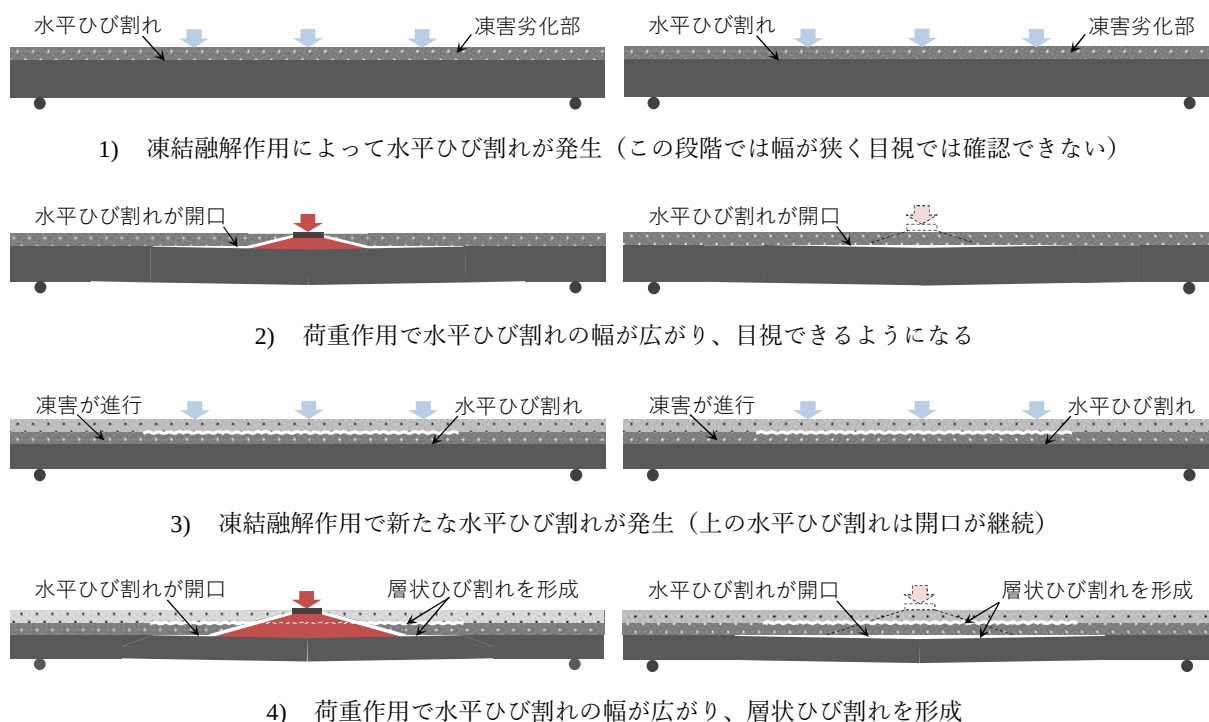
凍害による水平ひび割れの発生と荷重による幅の拡大が繰り返され層状ひび割れを形成（左：中央 右：外側断面）
